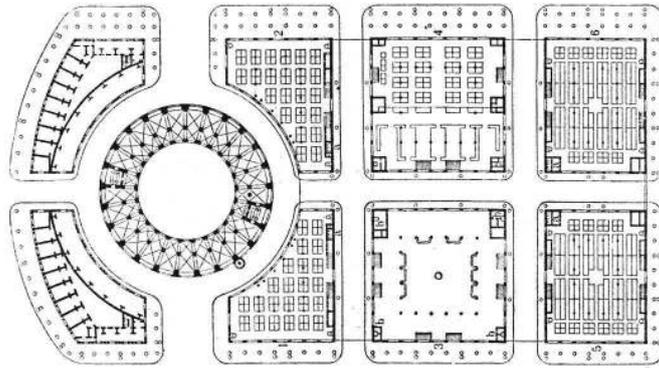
Planta de parte dos *Halles Centrales* de Paris
